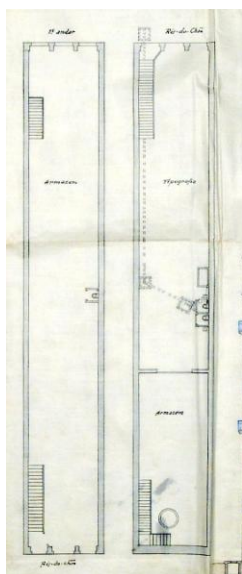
Planta de Arquivo do piso 0 e piso -1 [6]
